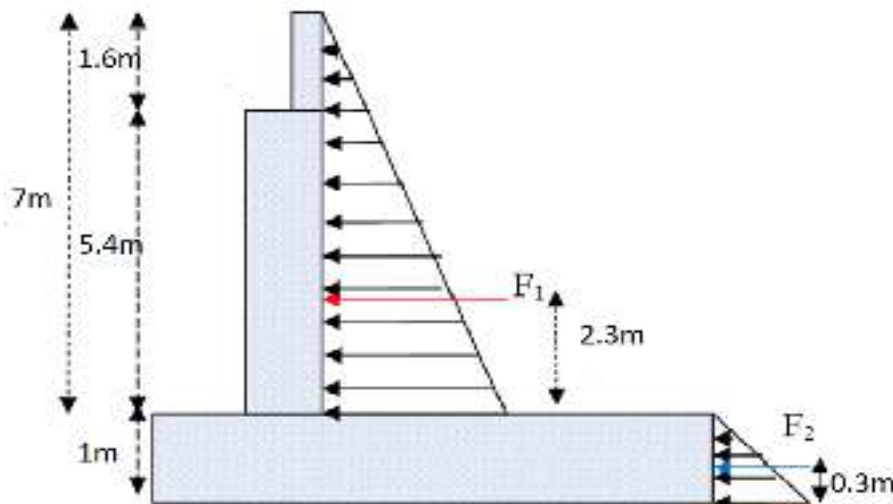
Poussée des terres sur (le mur frontal + mur garde grève et la semelle)
